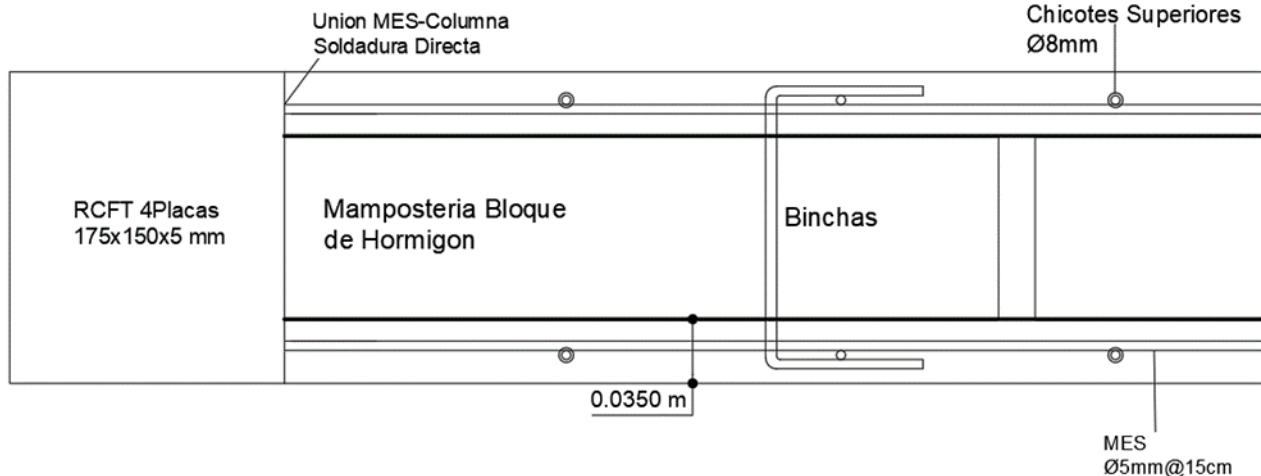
Esquema en planta de posible conexión entre columnas y enchape del prototipo I
